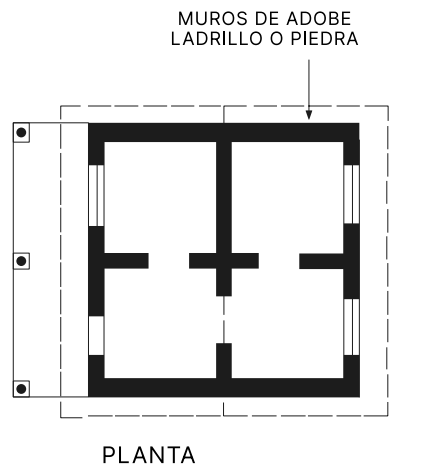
Sistema adintelado aplicado a construcciones locales de Guatemala
